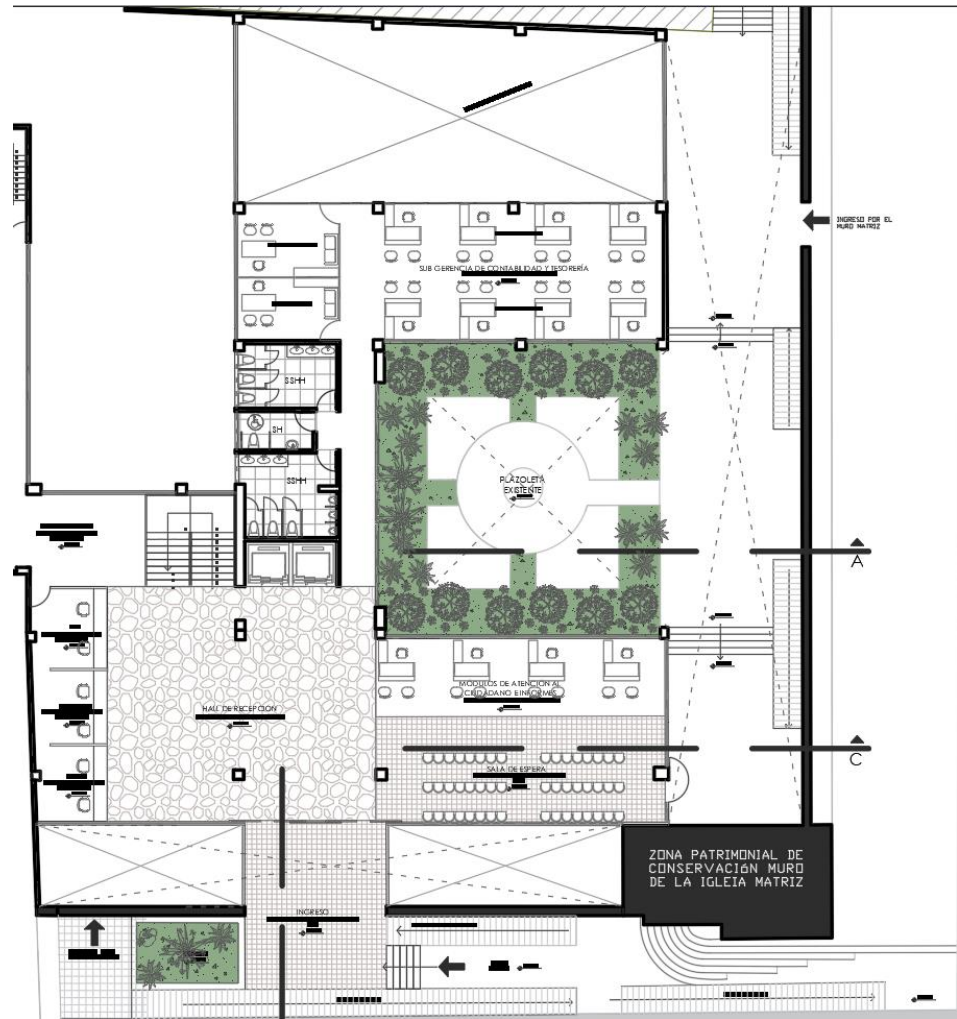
Planta de primer nivel donde se observan las estructuras que se mantienen.
